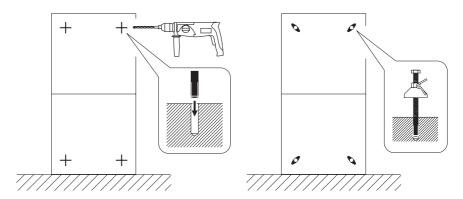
Inserimento di tasselli e del blocco di fissaggio
